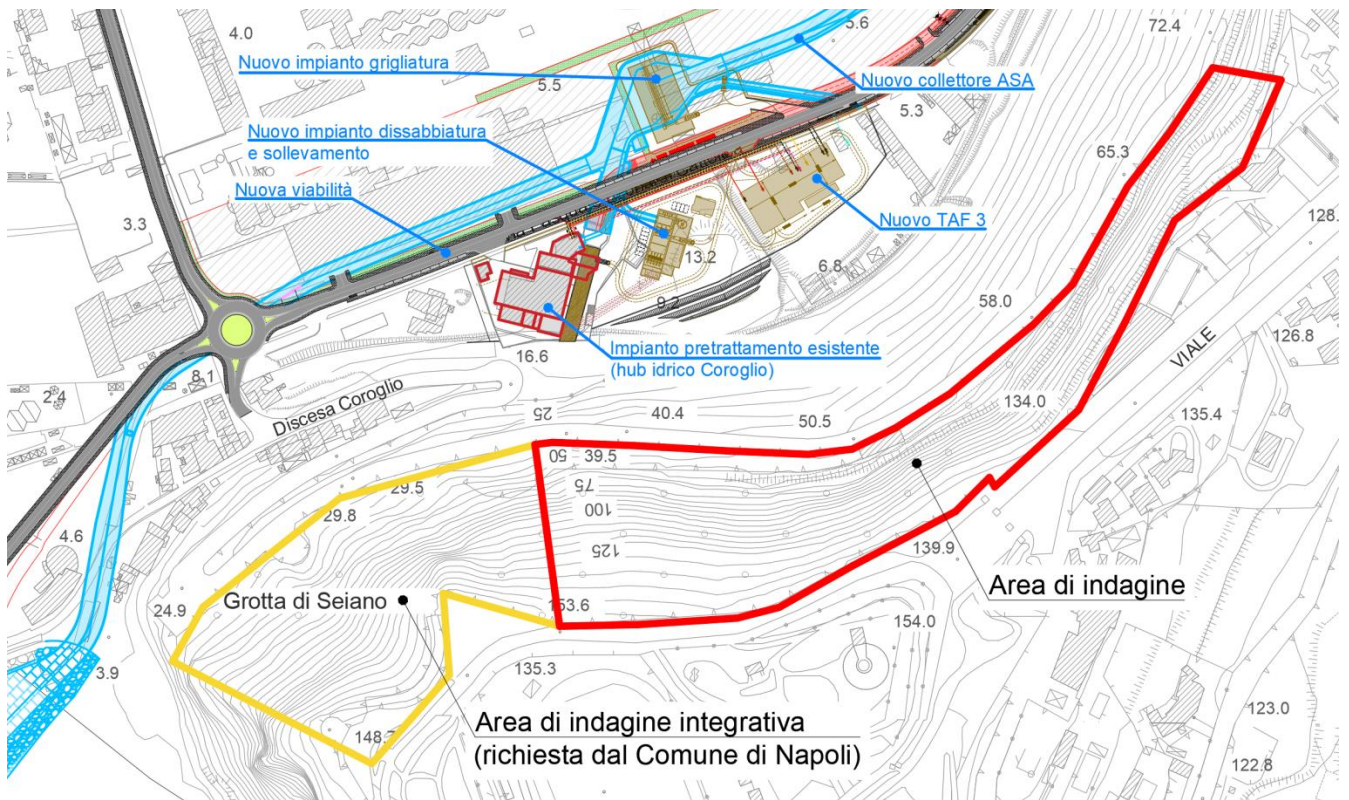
Schema planimetrico dell'area interessata dall'ispezione (rosso) e dell'area di espansione (giallo)
